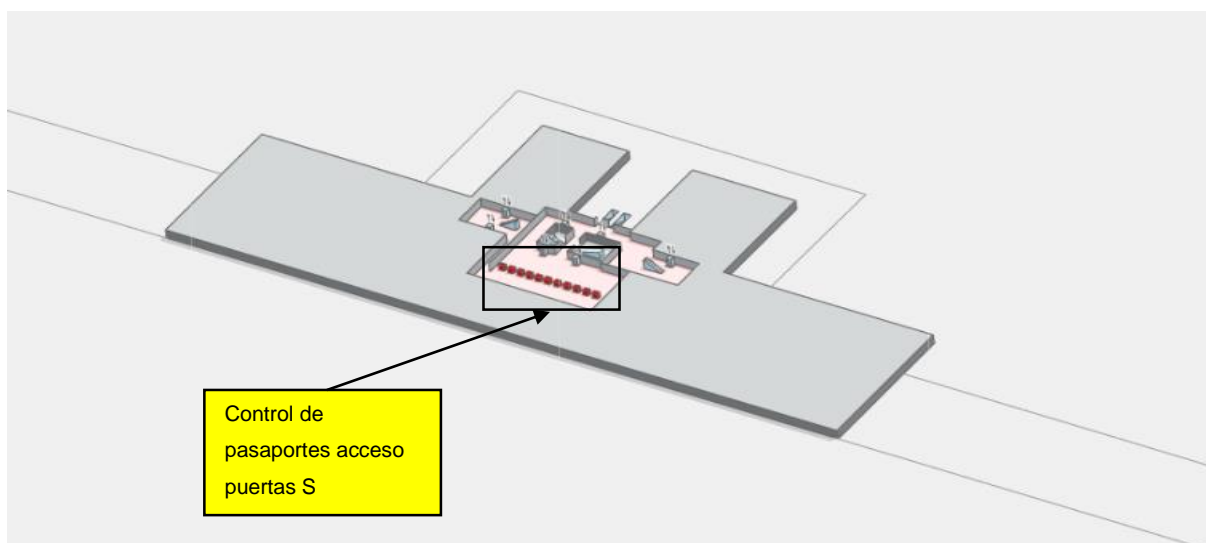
DISPOSICIÓN DE MEDIOS EN T4S - CONTROL DE PASAPORTES ACCESO A PUERTAS S PLANTA -1
